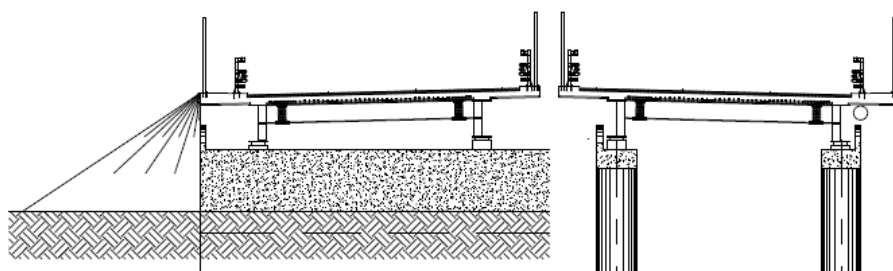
sezione trasversale dell'impalcato a struttura mista acciaio-calcestruzzo
